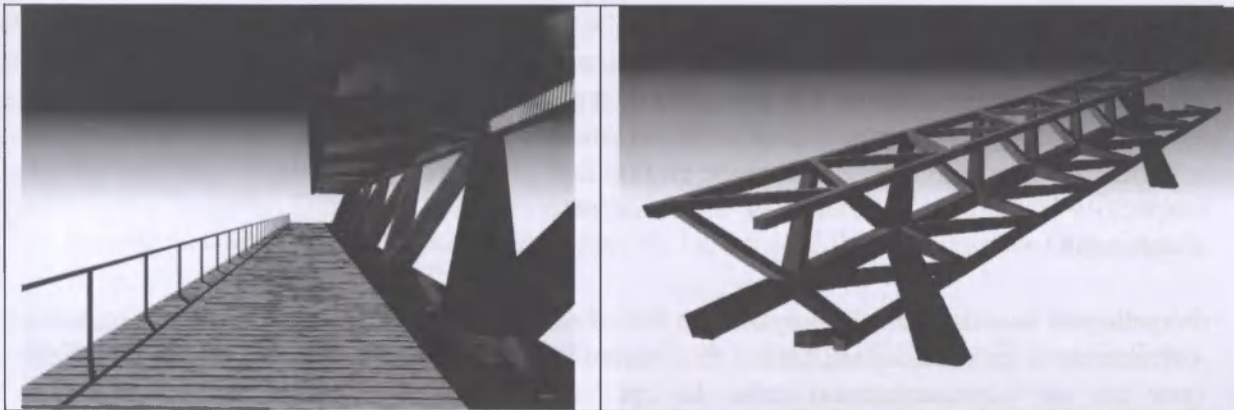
Imagen 3D del tramo en pasarela del paseo peatonal. La estructura consiste en una serie de pilas de hormigón armado inclinadas y con forma de Y, y dos bandejas de vigas metálicas en celosía, donde descansan los tabloncillos de madera tratada del paseo y la cubierta, a modo de visera (cortesía de Jofrahesa, S.A.)
